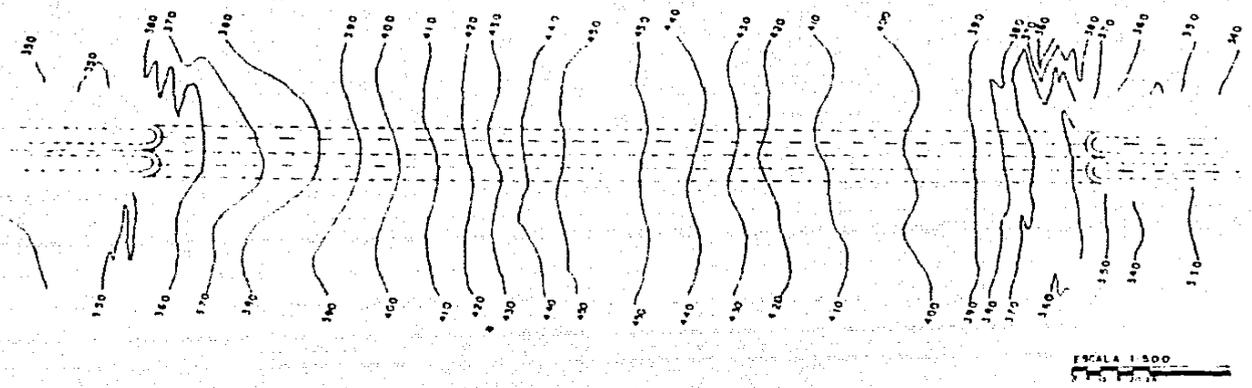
PLANTA TOPOGRAFICA Y PERFIL DEL TERRENO
